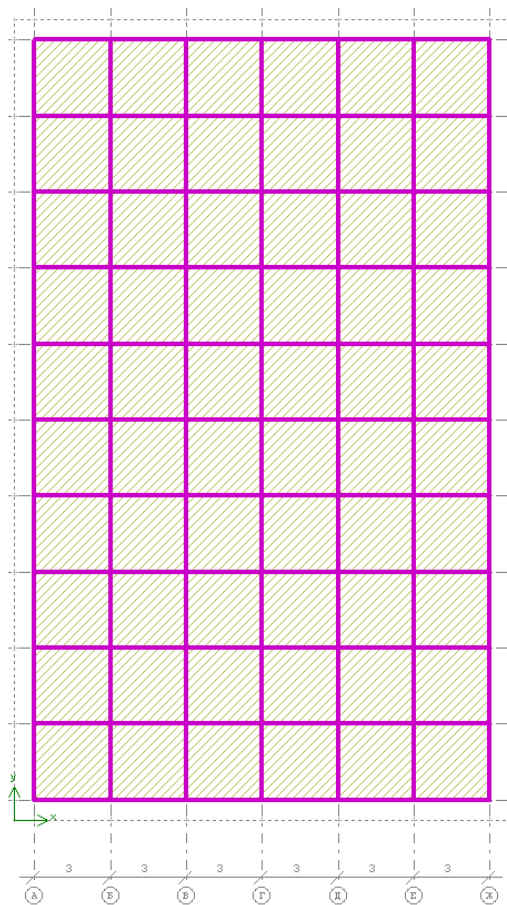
Стены и плиты перекрытия надсилосного этажа
